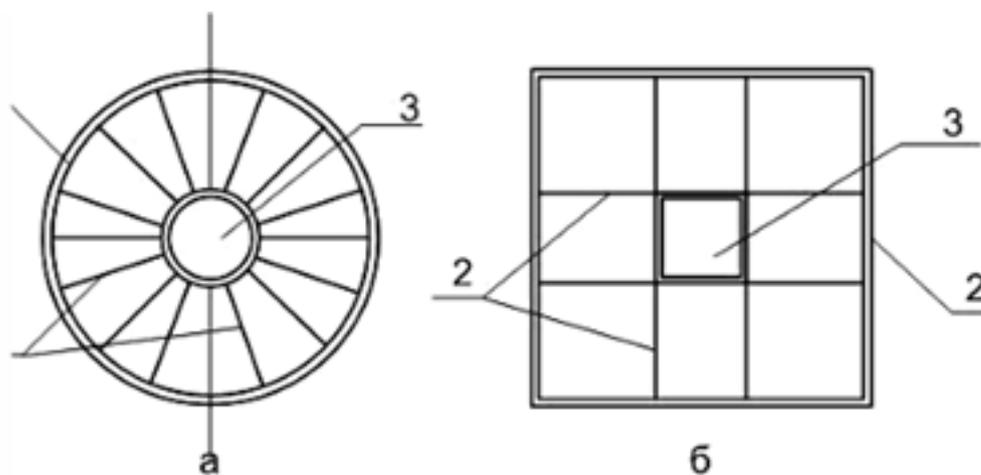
Ствольные здания: а) с радиальным расположением несущих стен; б) с перекрестным расположением несущих стен; 1 - ненесущая стена; 2 - несущая стена; 3 - монолитный железобетонный ствол.
